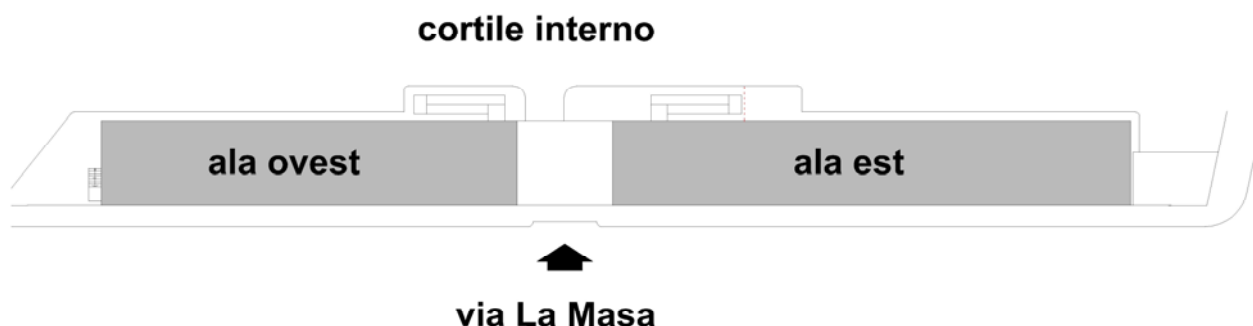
Schema planimetrico piano rialzato con evidenziazione delle ali
